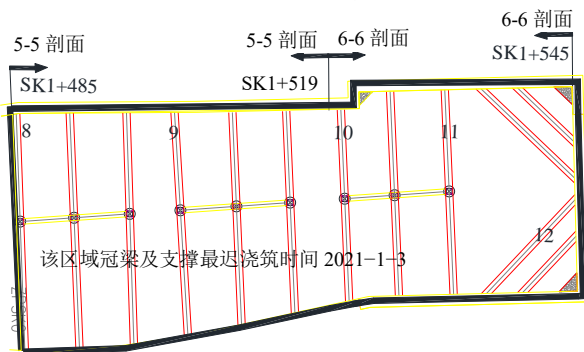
基坑 SK1+485~SK1+545 段第1道混凝土支撑梁平面布置图
